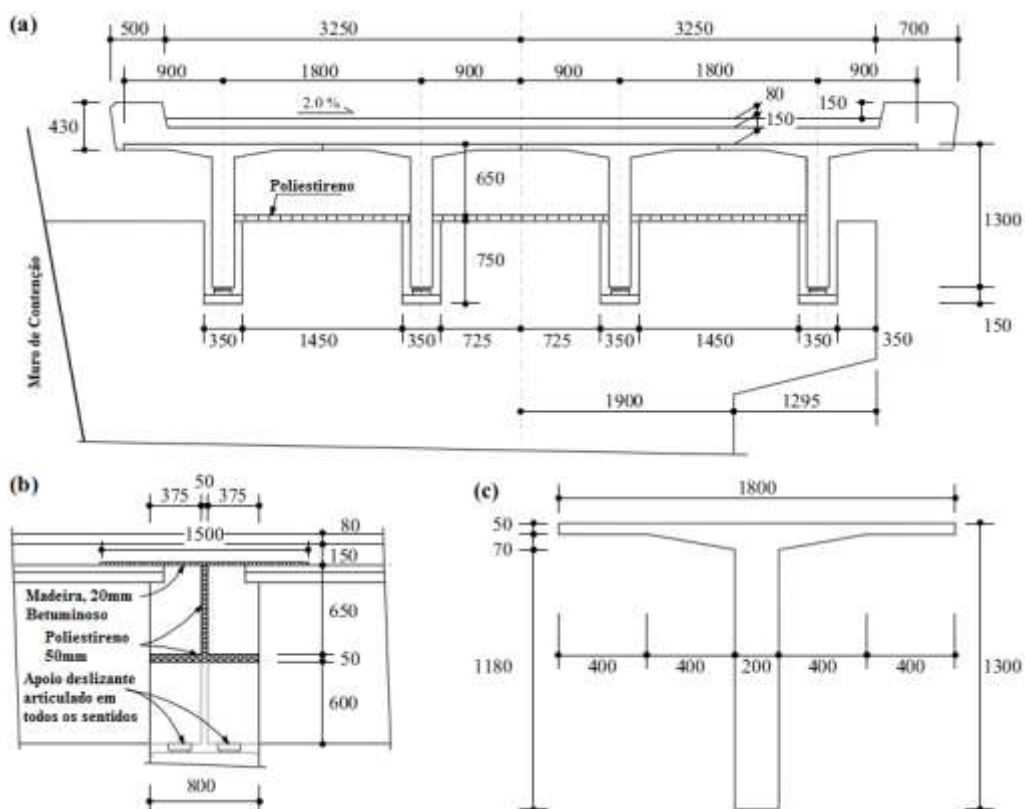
Representação do viaduto Wassnerwald (dimensões em mm): (a) Secção transversal sobre o apoio; (b) Detalhe da construção do apoio articulado e ligação de vãos; (c) Dimensões pormenorizadas das vigas pré-fabricadas [38].
